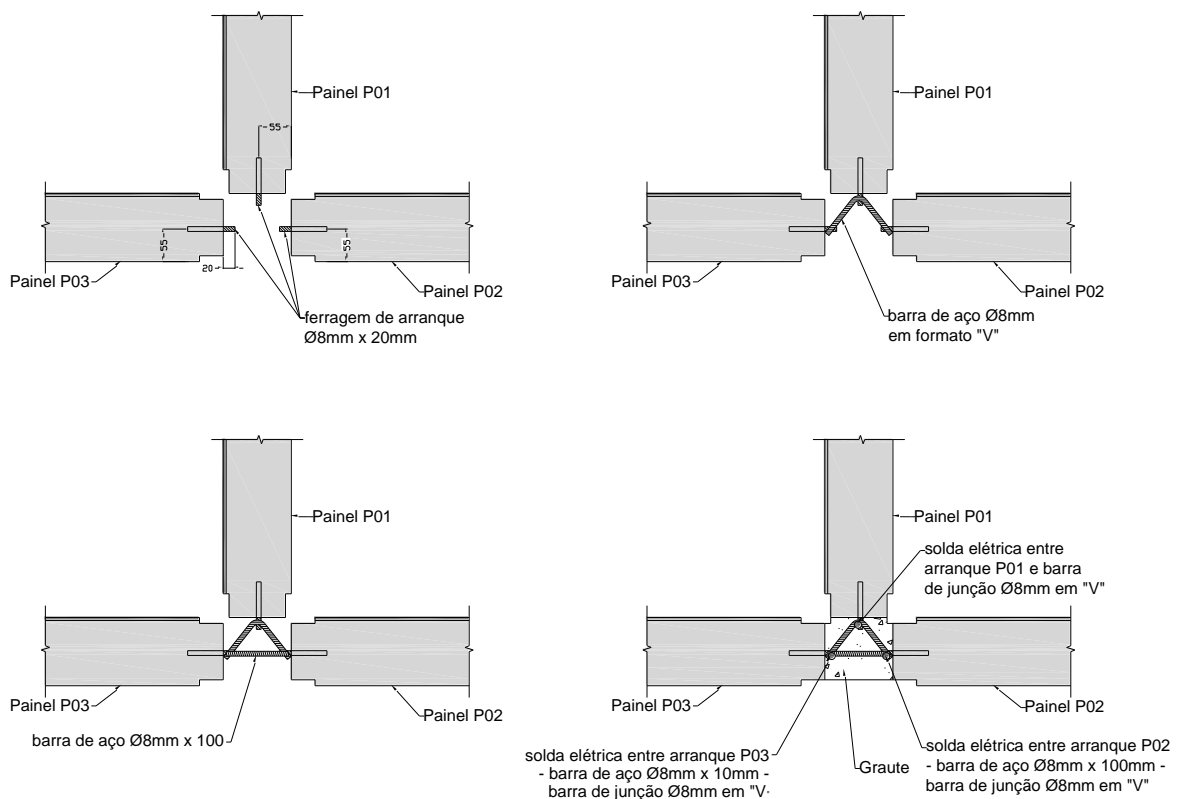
Exemplo da sequencia de montagem de uma junta vertical típica entre painéis de parede (vista em planta)
